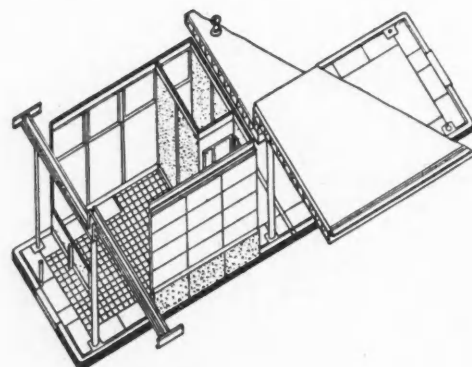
DETAILS CONSTRUCTIFS D'UN PANNEAU :
